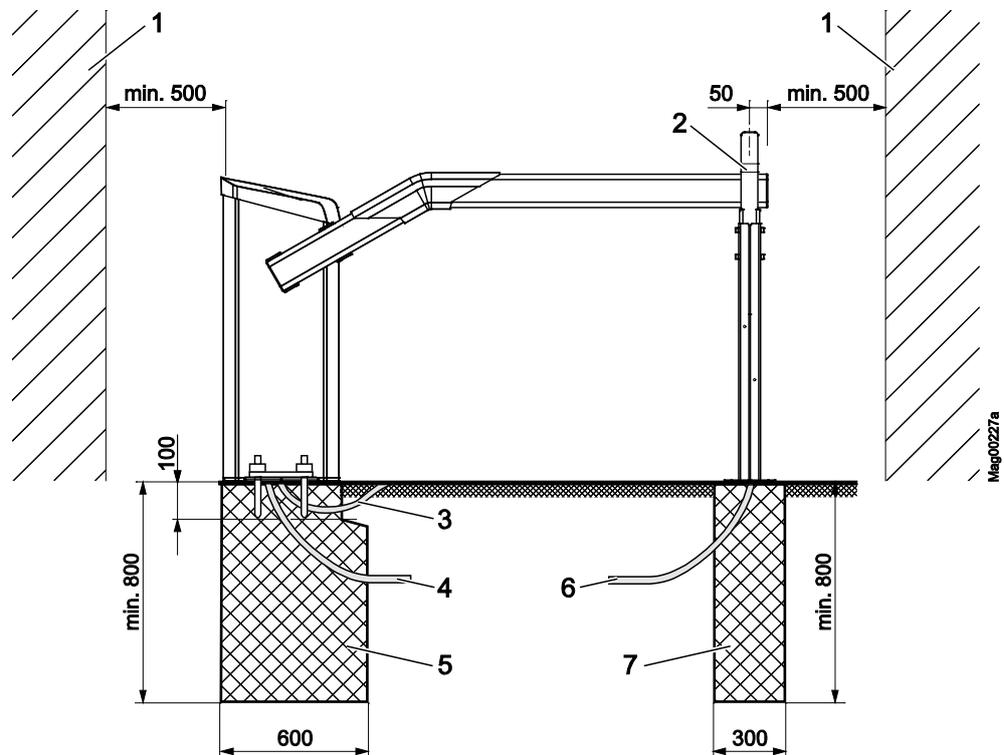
Montage Schrankenanlage, hier dargestellt für Schrankentyp "Access/Parking" (Maße in mm)
